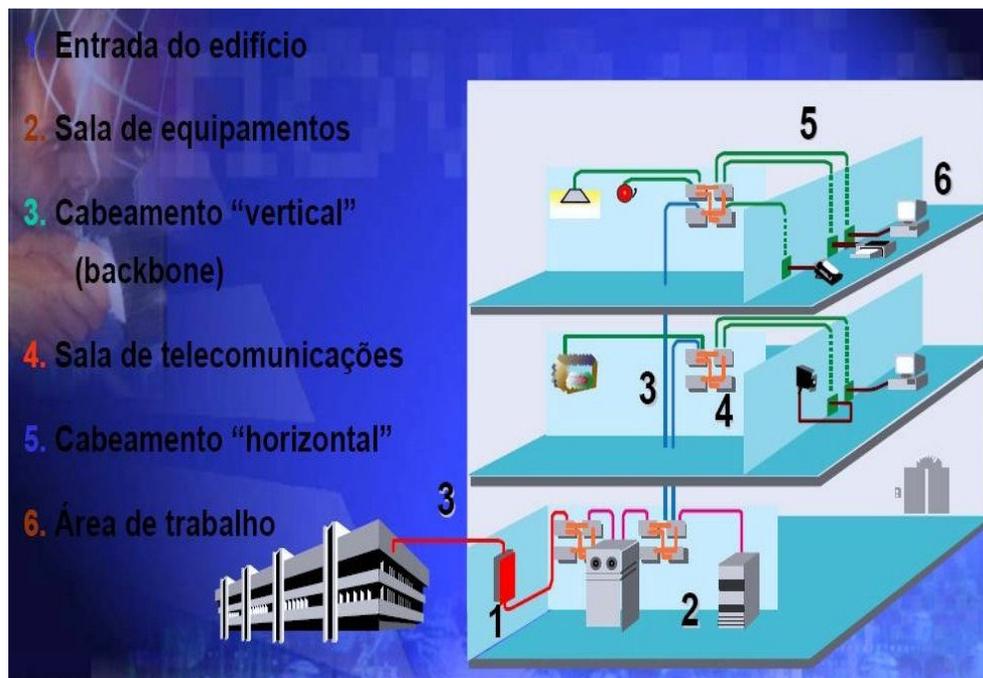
Sistemas do Cabeamento Estruturado [PINHEIRO, 2003]
